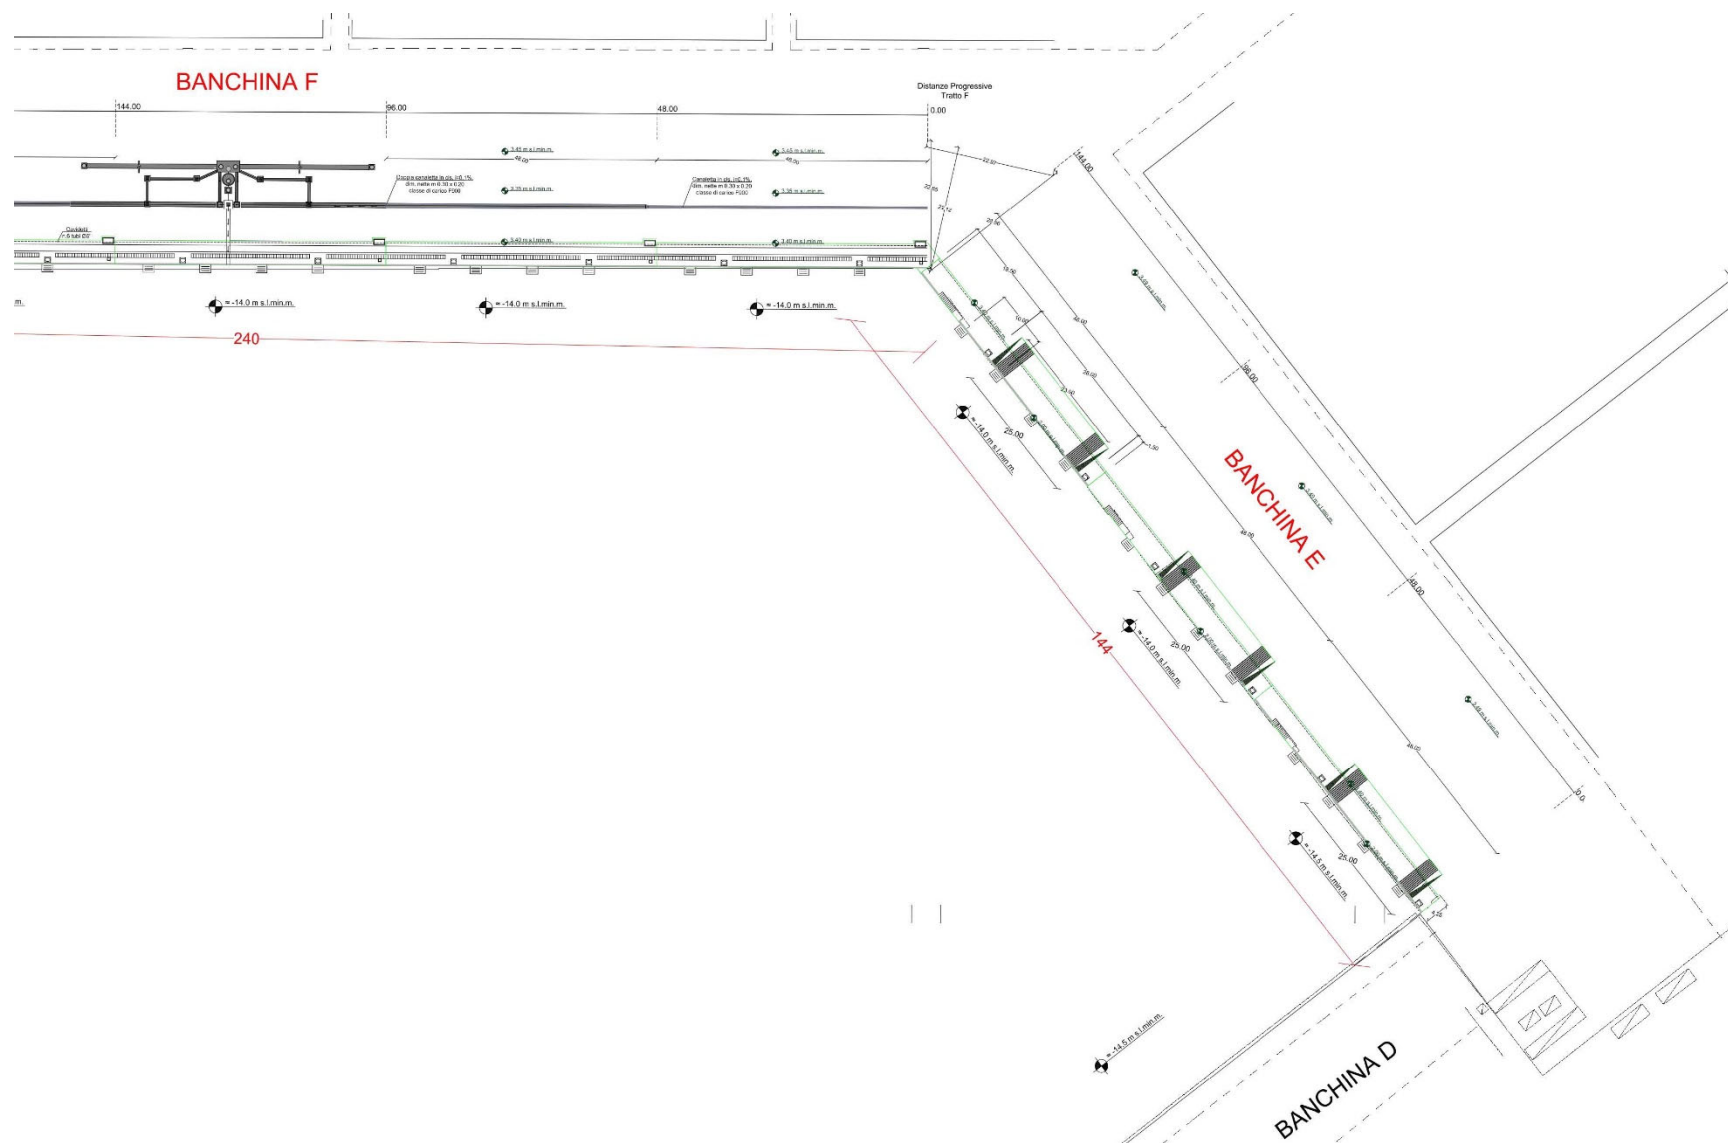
Planimetria Banchine "E" ed "F" stato attuale
